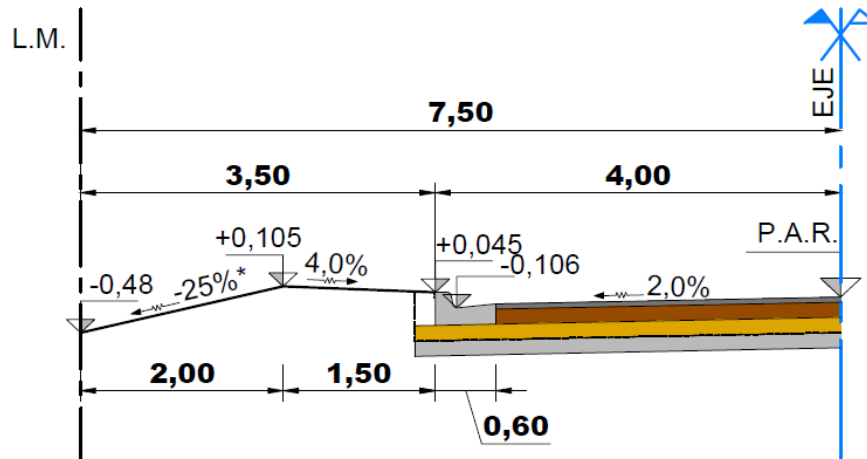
Esquema del perfil transversal para calles de ocho metros de ancho.
